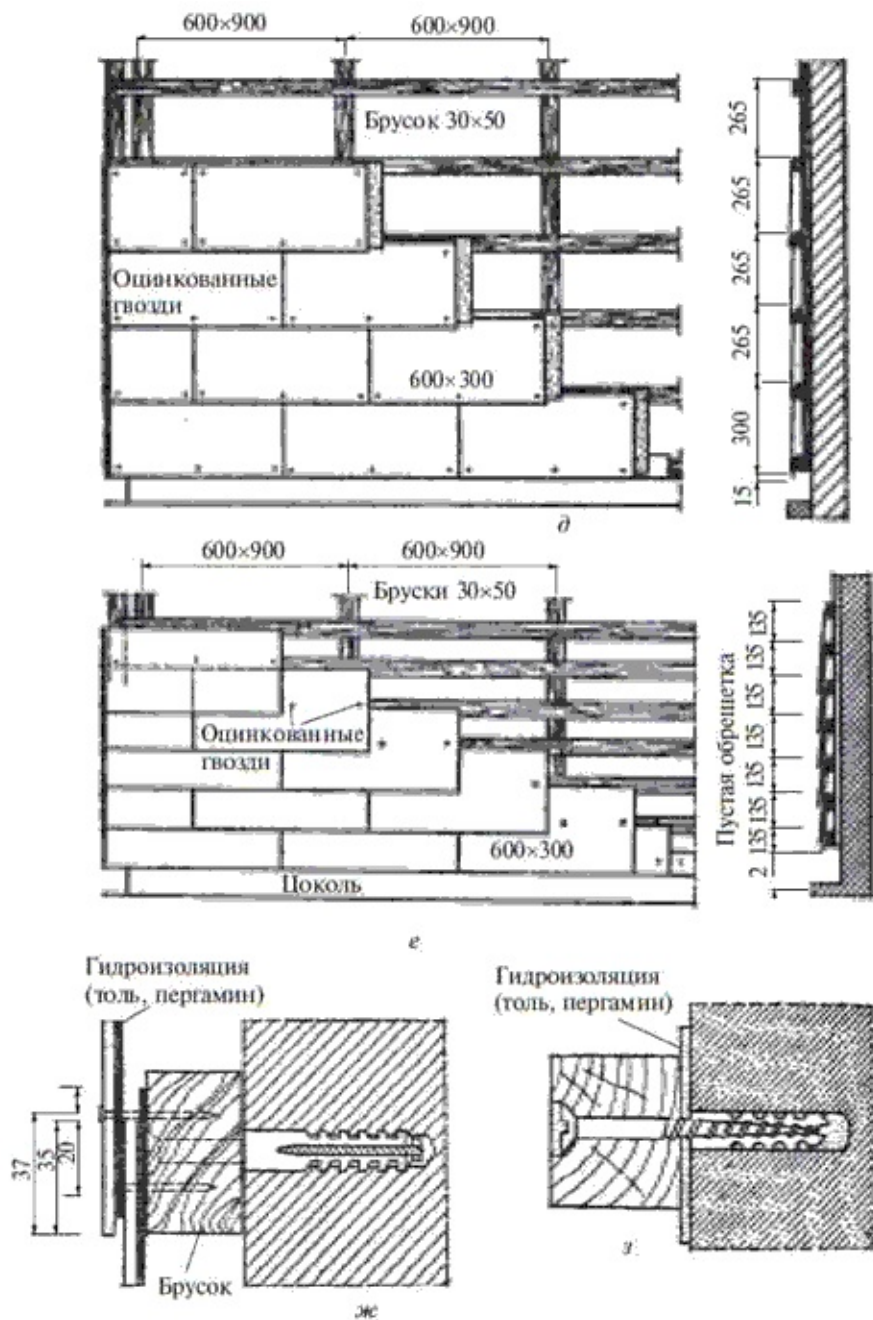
(продолжение). Крепление крупноразмерных листов на фасаде здания: д, е – к горизонтальному каркасу, прикрепленному к вертикальным брускам; ж – к брускам; з – крепление брусков с прокладкой пергамин
